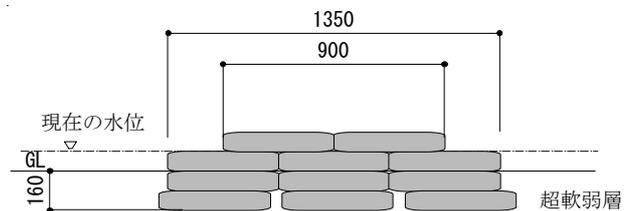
沼地載荷試験での土のう配置図 (寸法:mm)
